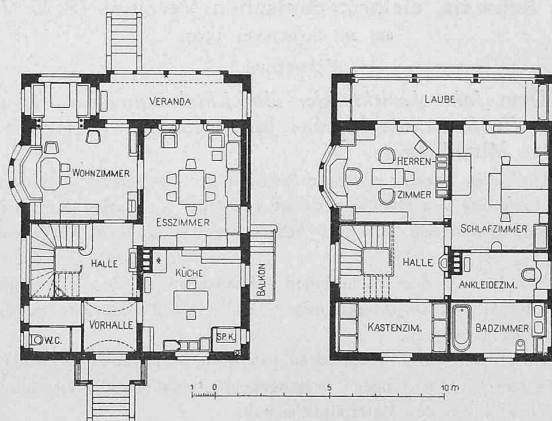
u. 3. Grundrisse vom Erd- und Obergeschoss. — 1:400.
